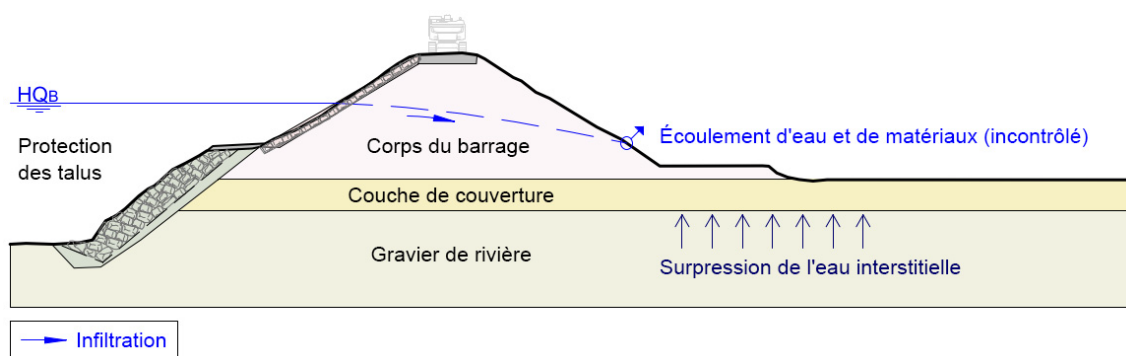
Profil transversal d'une digue de protection contre les crues sur un sol de fondation typique des rivières de vallée du Plateau suisse (exemple du Rhin alpin).
